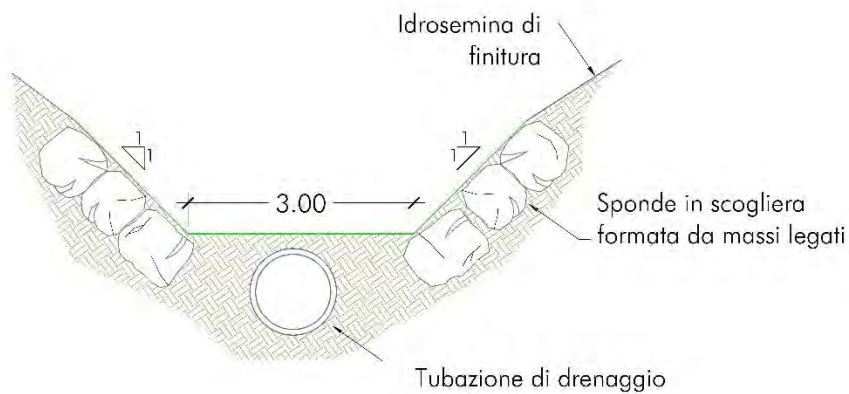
Sezione tipologica di sistemazione di un canale con scogliera e tubazione di drenaggio.
